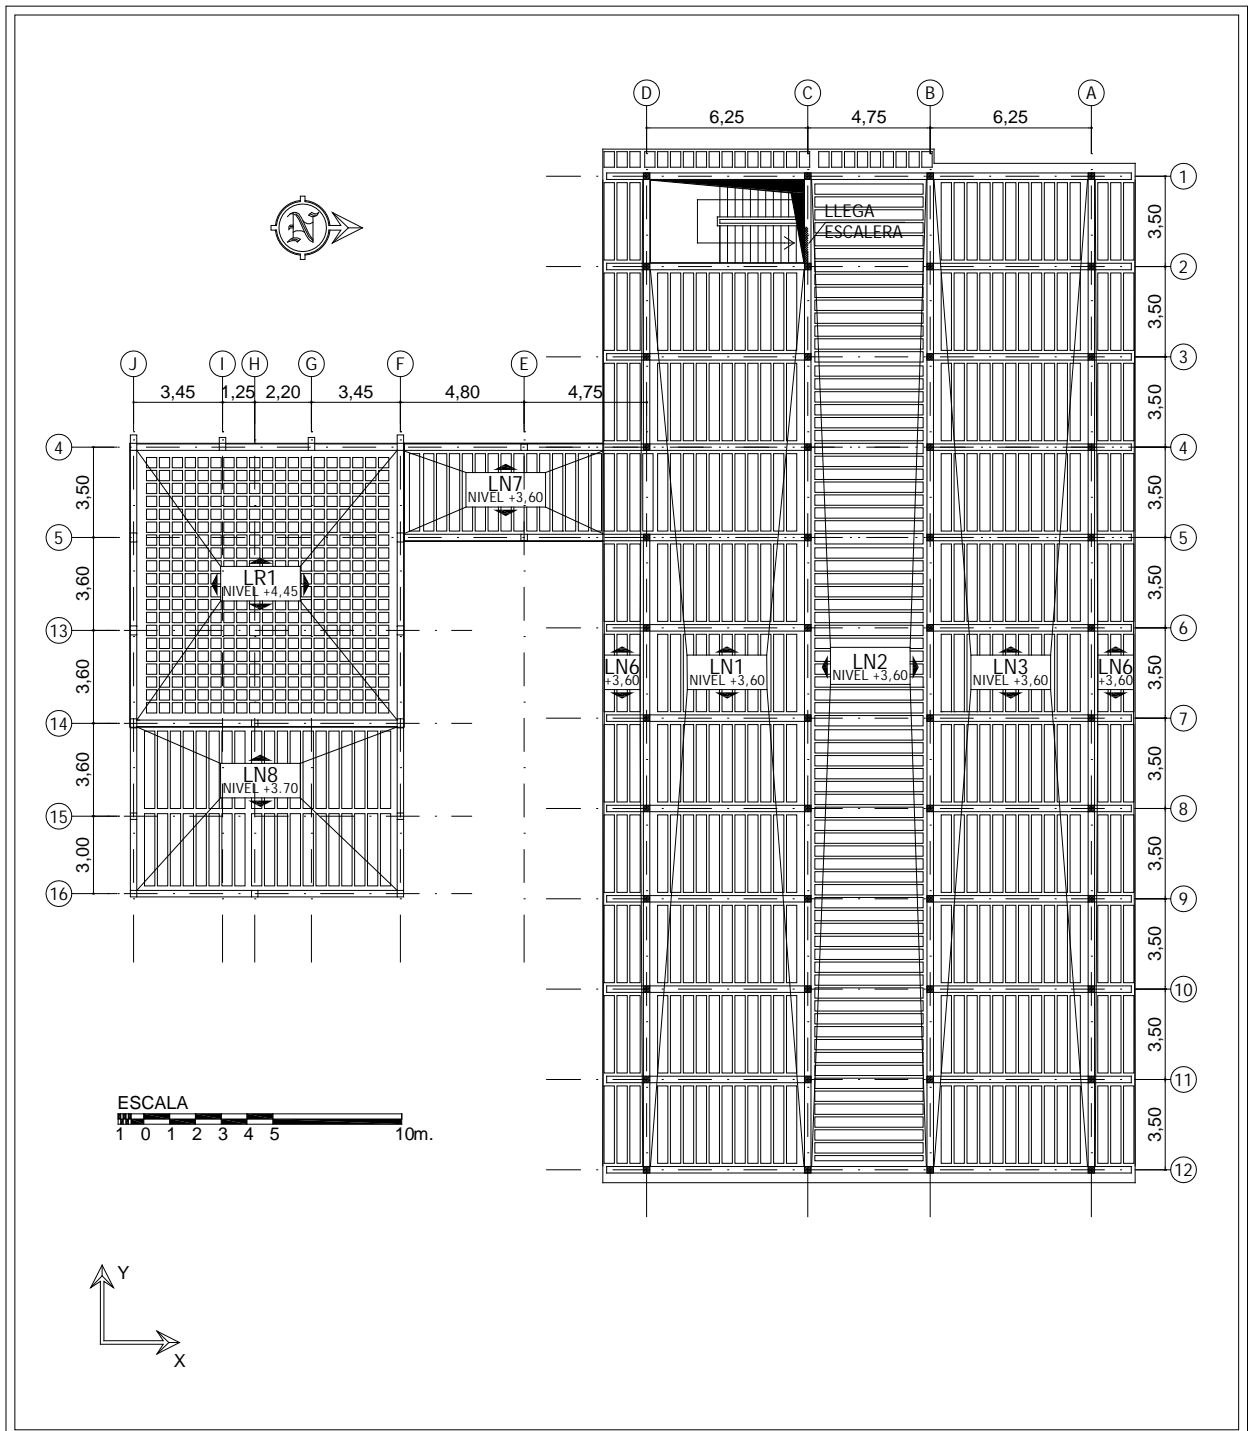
Plano del envigado de la planta alta. Nótese que el Módulo Principal y el Módulo Anexo están conectados rígidamente.
